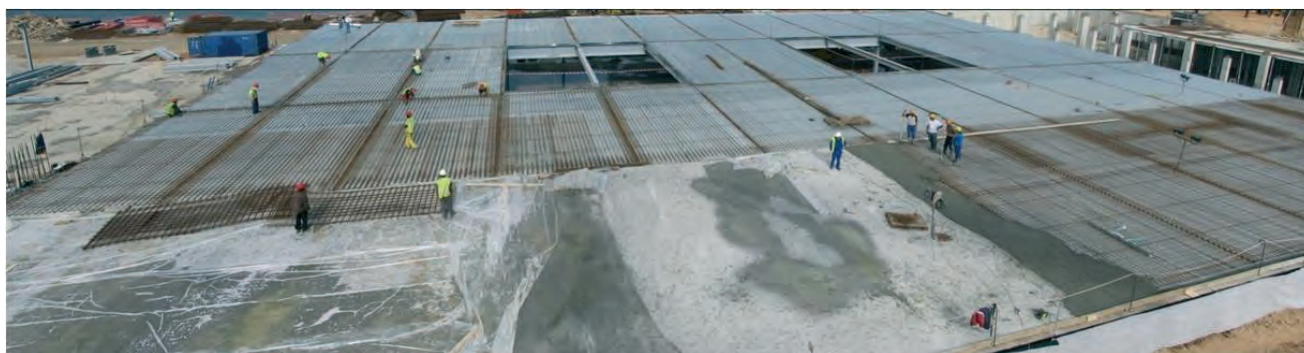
Vista de la cubierta del restaurante durante su ejecución
